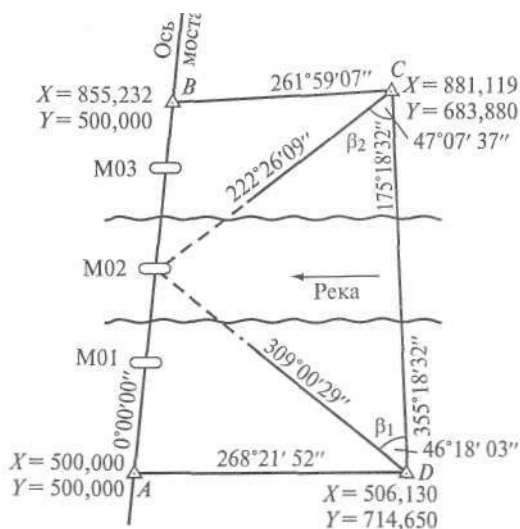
Схема разбивки центров мостовых опор прямой угловой засечкой
